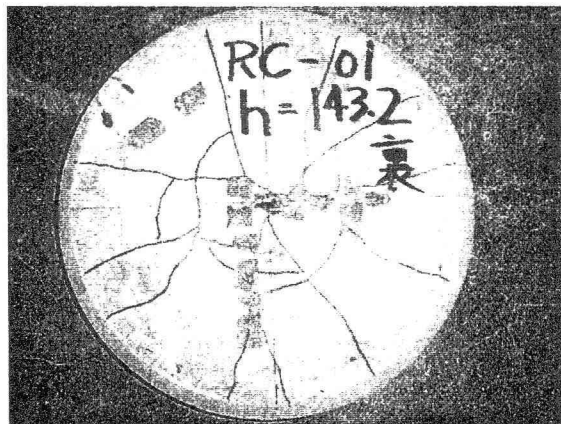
裏面剥離した鉄筋コンクリート版の裏面
